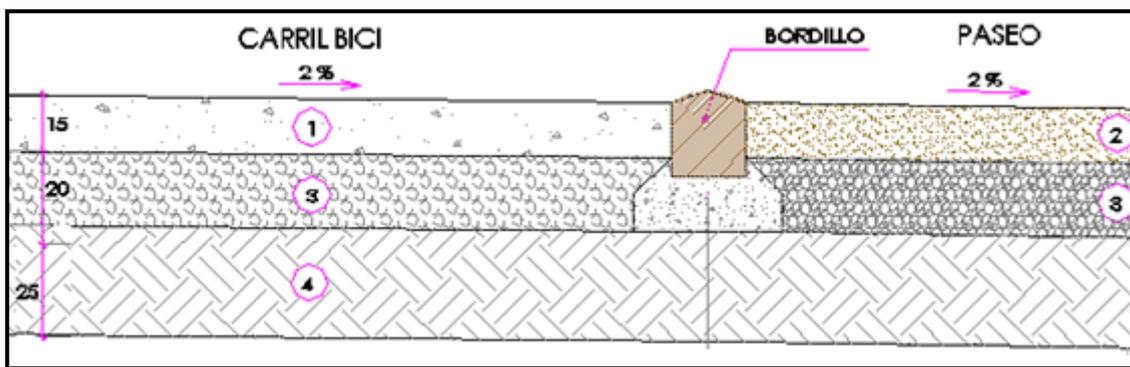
Detalle del sendero de hormigón peinado y “sauló”, donde 1= Hormigón peinado (con mallazo 0.6x0.15x0.15) juntas con corte radial 3= Zorra artificial y 4= Pedraplen o terreno natural tratado y compactado
